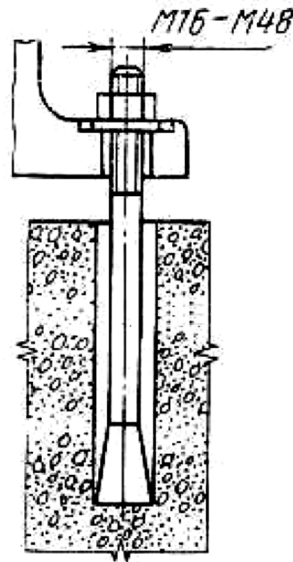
Глухий конічний фундаментний болт, що встановлюється в готові фундаменти з зачеканенням цементним розчином
